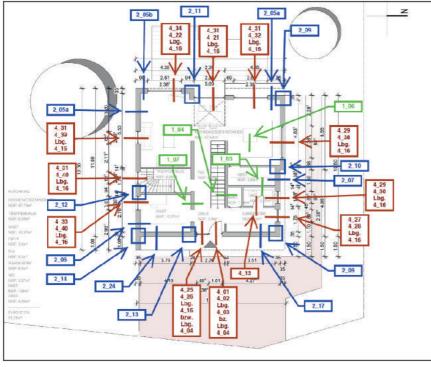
Grundriss des Erdgeschosses mit markierten Wärmebrücken
